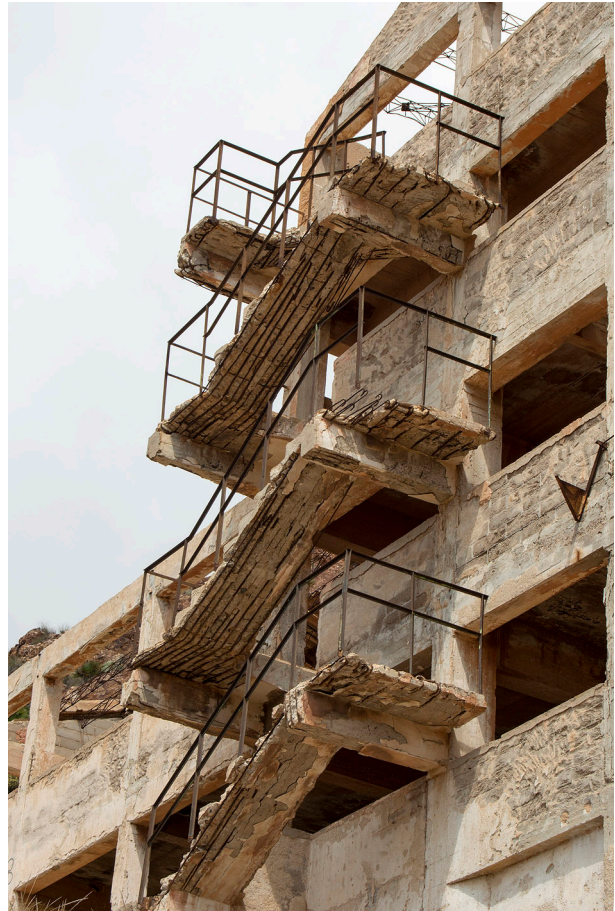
Escalera de libre acceso a uno de los edificios de trituración de la Planta Denver donde se observa el estado del forjado que sustenta la estructura. Autoría propia.
